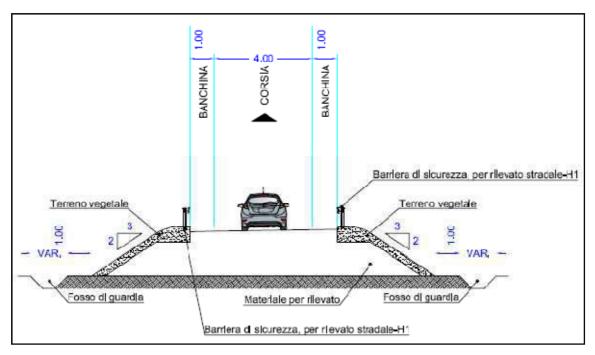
Sezione tipo, rampe a senso unico in rilevato
